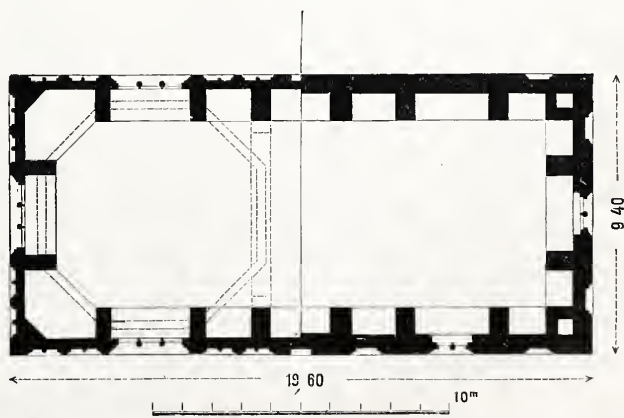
Detail-Grundriss des Thurm-Aufbaues.
